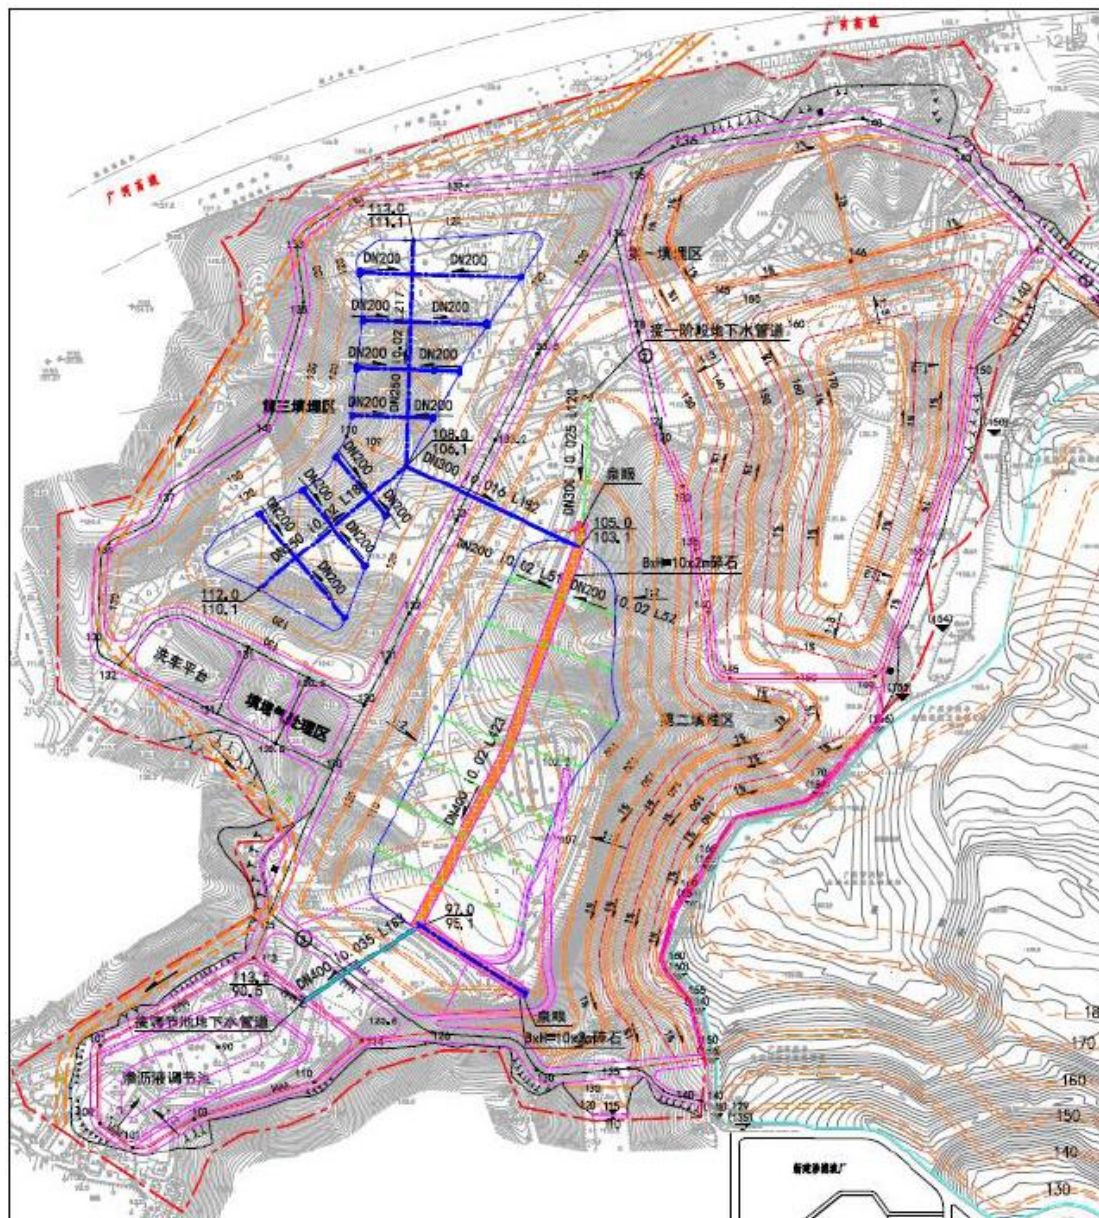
第三填埋区建设地下水收集和导排系统平面图
